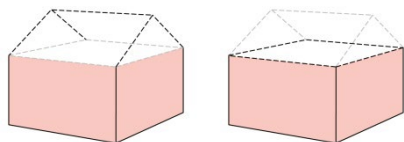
Transformation de la toiture. Une toiture en pente est transformée en toiture plate ou une toiture plate est transformée en toiture en pente.
